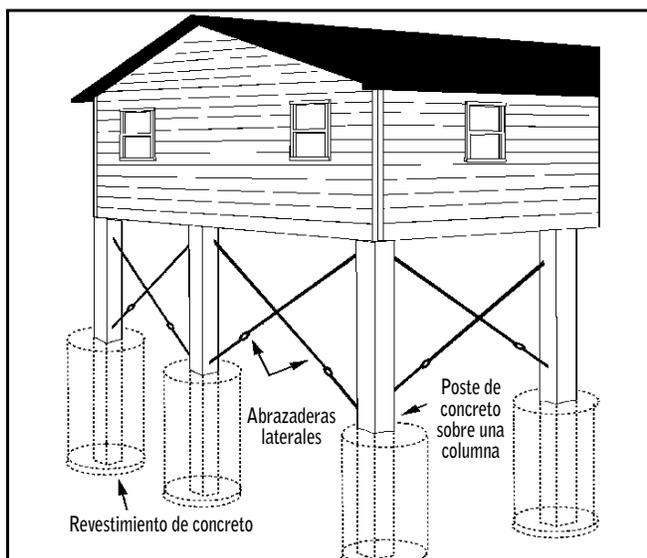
Para viviendas elevadas sobre postes o columnas, recubra los postes con concreto y proporcione abrazaderas laterales.
